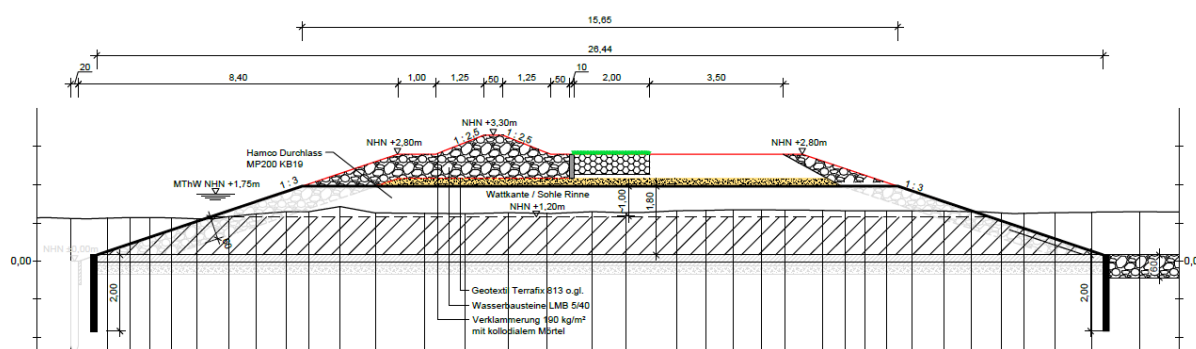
Durchlassbauwerk mittlere Rinne, Querschnitt (Planausschnitt Detail B, Anlage 2.5, Blatt 1)
